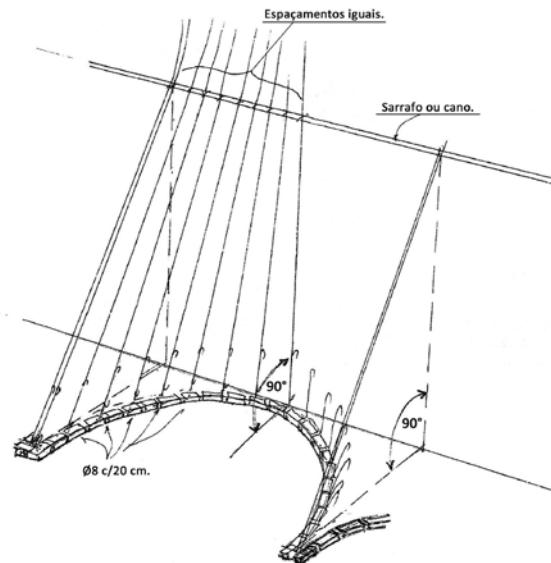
Detalhe das armaduras para levantamento da parede do oitão. (*-5).
